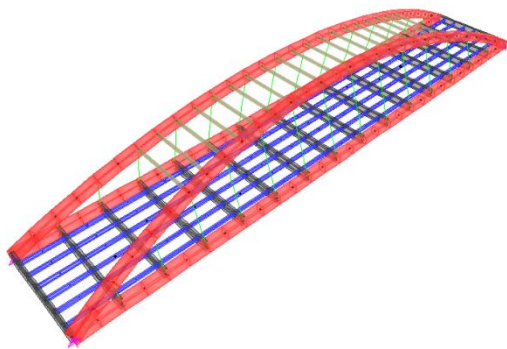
Variasi model pembebanan pada balok melintang (*cross girder*).
